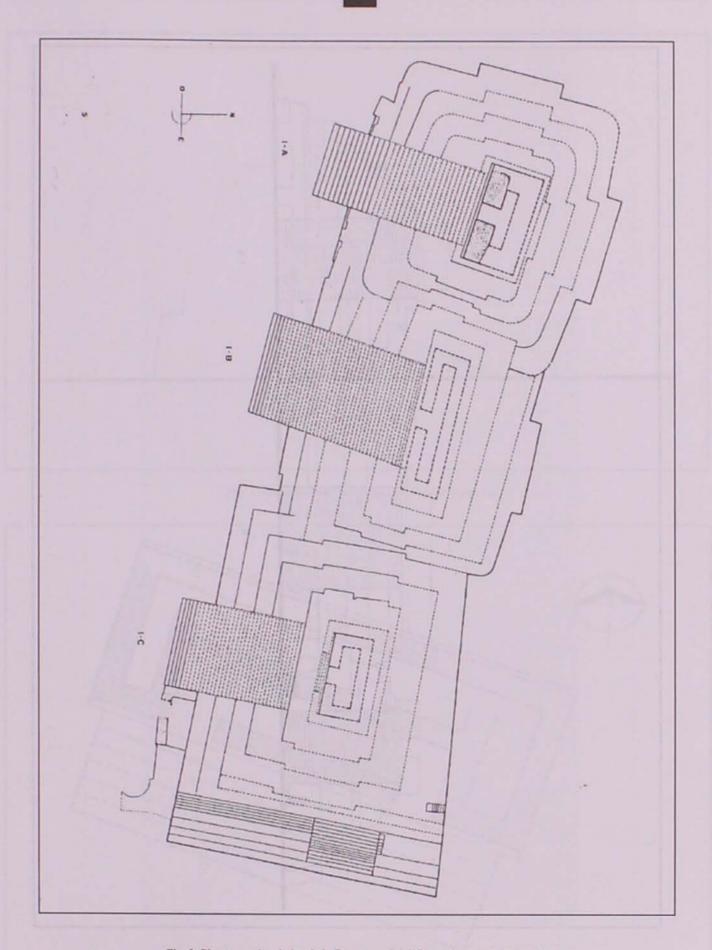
Planta arquitectònica de la Estructura 1 del Grupo Central de Balamkù
